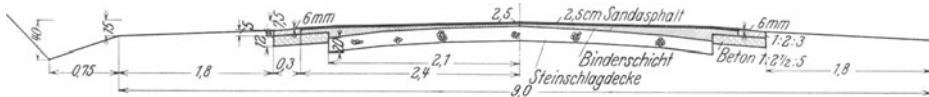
Sandasphalt auf Steinschlagdecke mit Verbreiterung.
